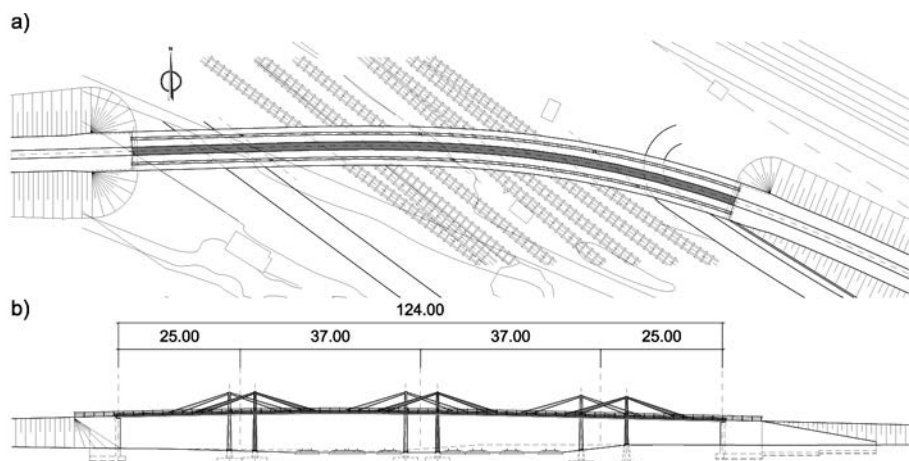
Puente extradosado; a) Vista en planta; b) Alzado longitudinal
